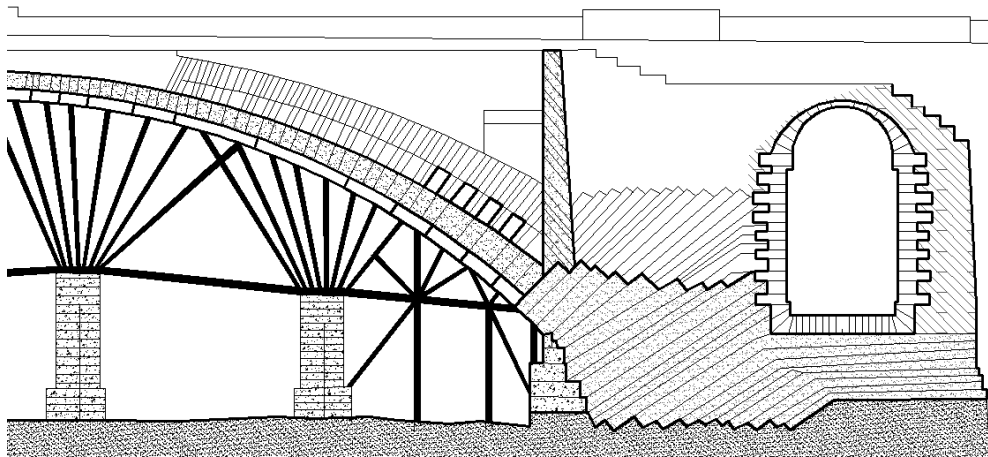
Puente construido con juntas inclinadas para evitar la falla de los estribos por deslizamiento de los bloques (Huerta, 1990)
